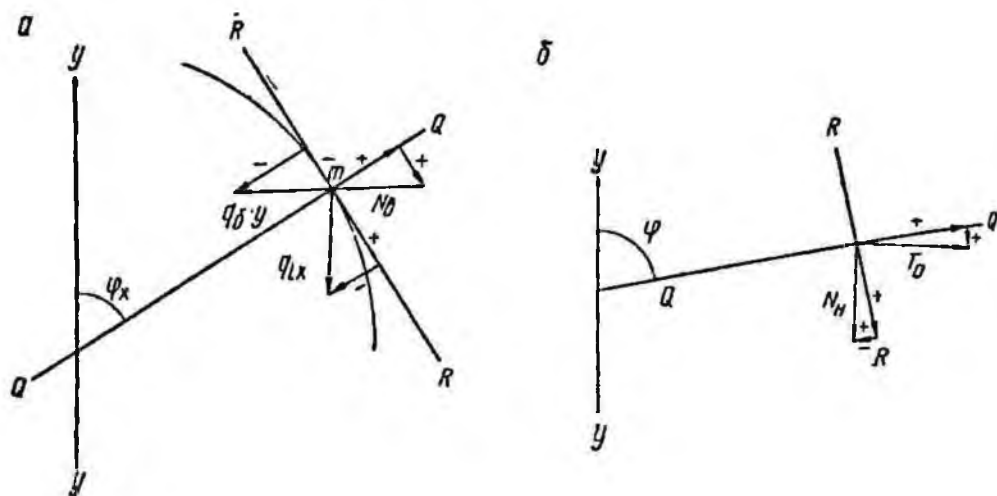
Схемы действия нагрузок на верхний элемент крепи ГТК: а — для поперечных усилий; б — для продольных усилий
